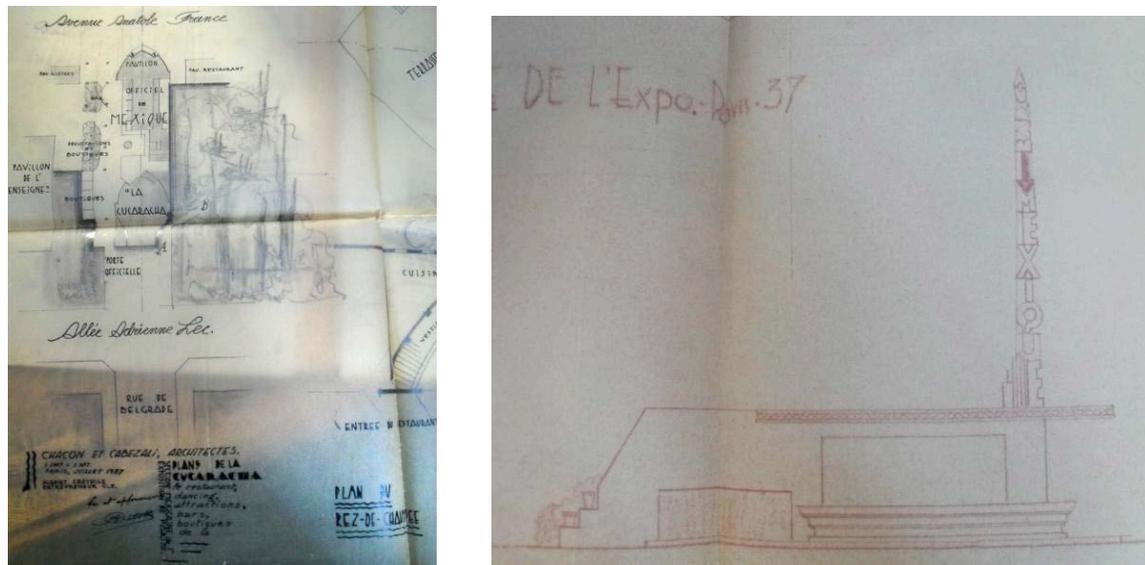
Ingeniero Manuel Chacón y Arquitectos Veysade, Nédonchelle y Vernaud, Planos arquitectónicos del pabellón mexicano y su anexo, 1937, Dossier Pavillon du Mexique, Centre d'Archives d'Architecture du XXe siècle/Cité de l'Architecture et le Patrimoine, Paris.
